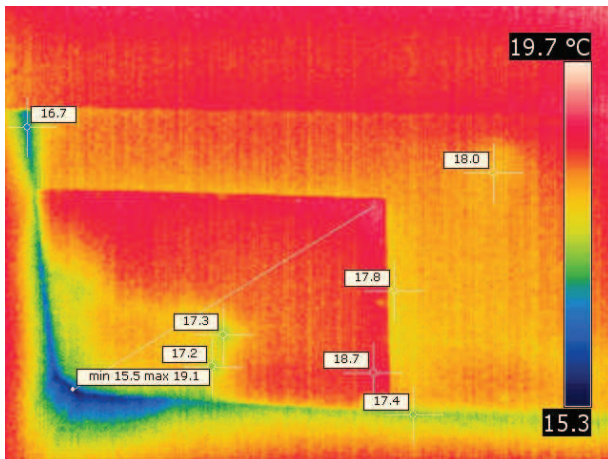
Стена лестничной клетки (окно закрыто фанерой), восточный фасад
